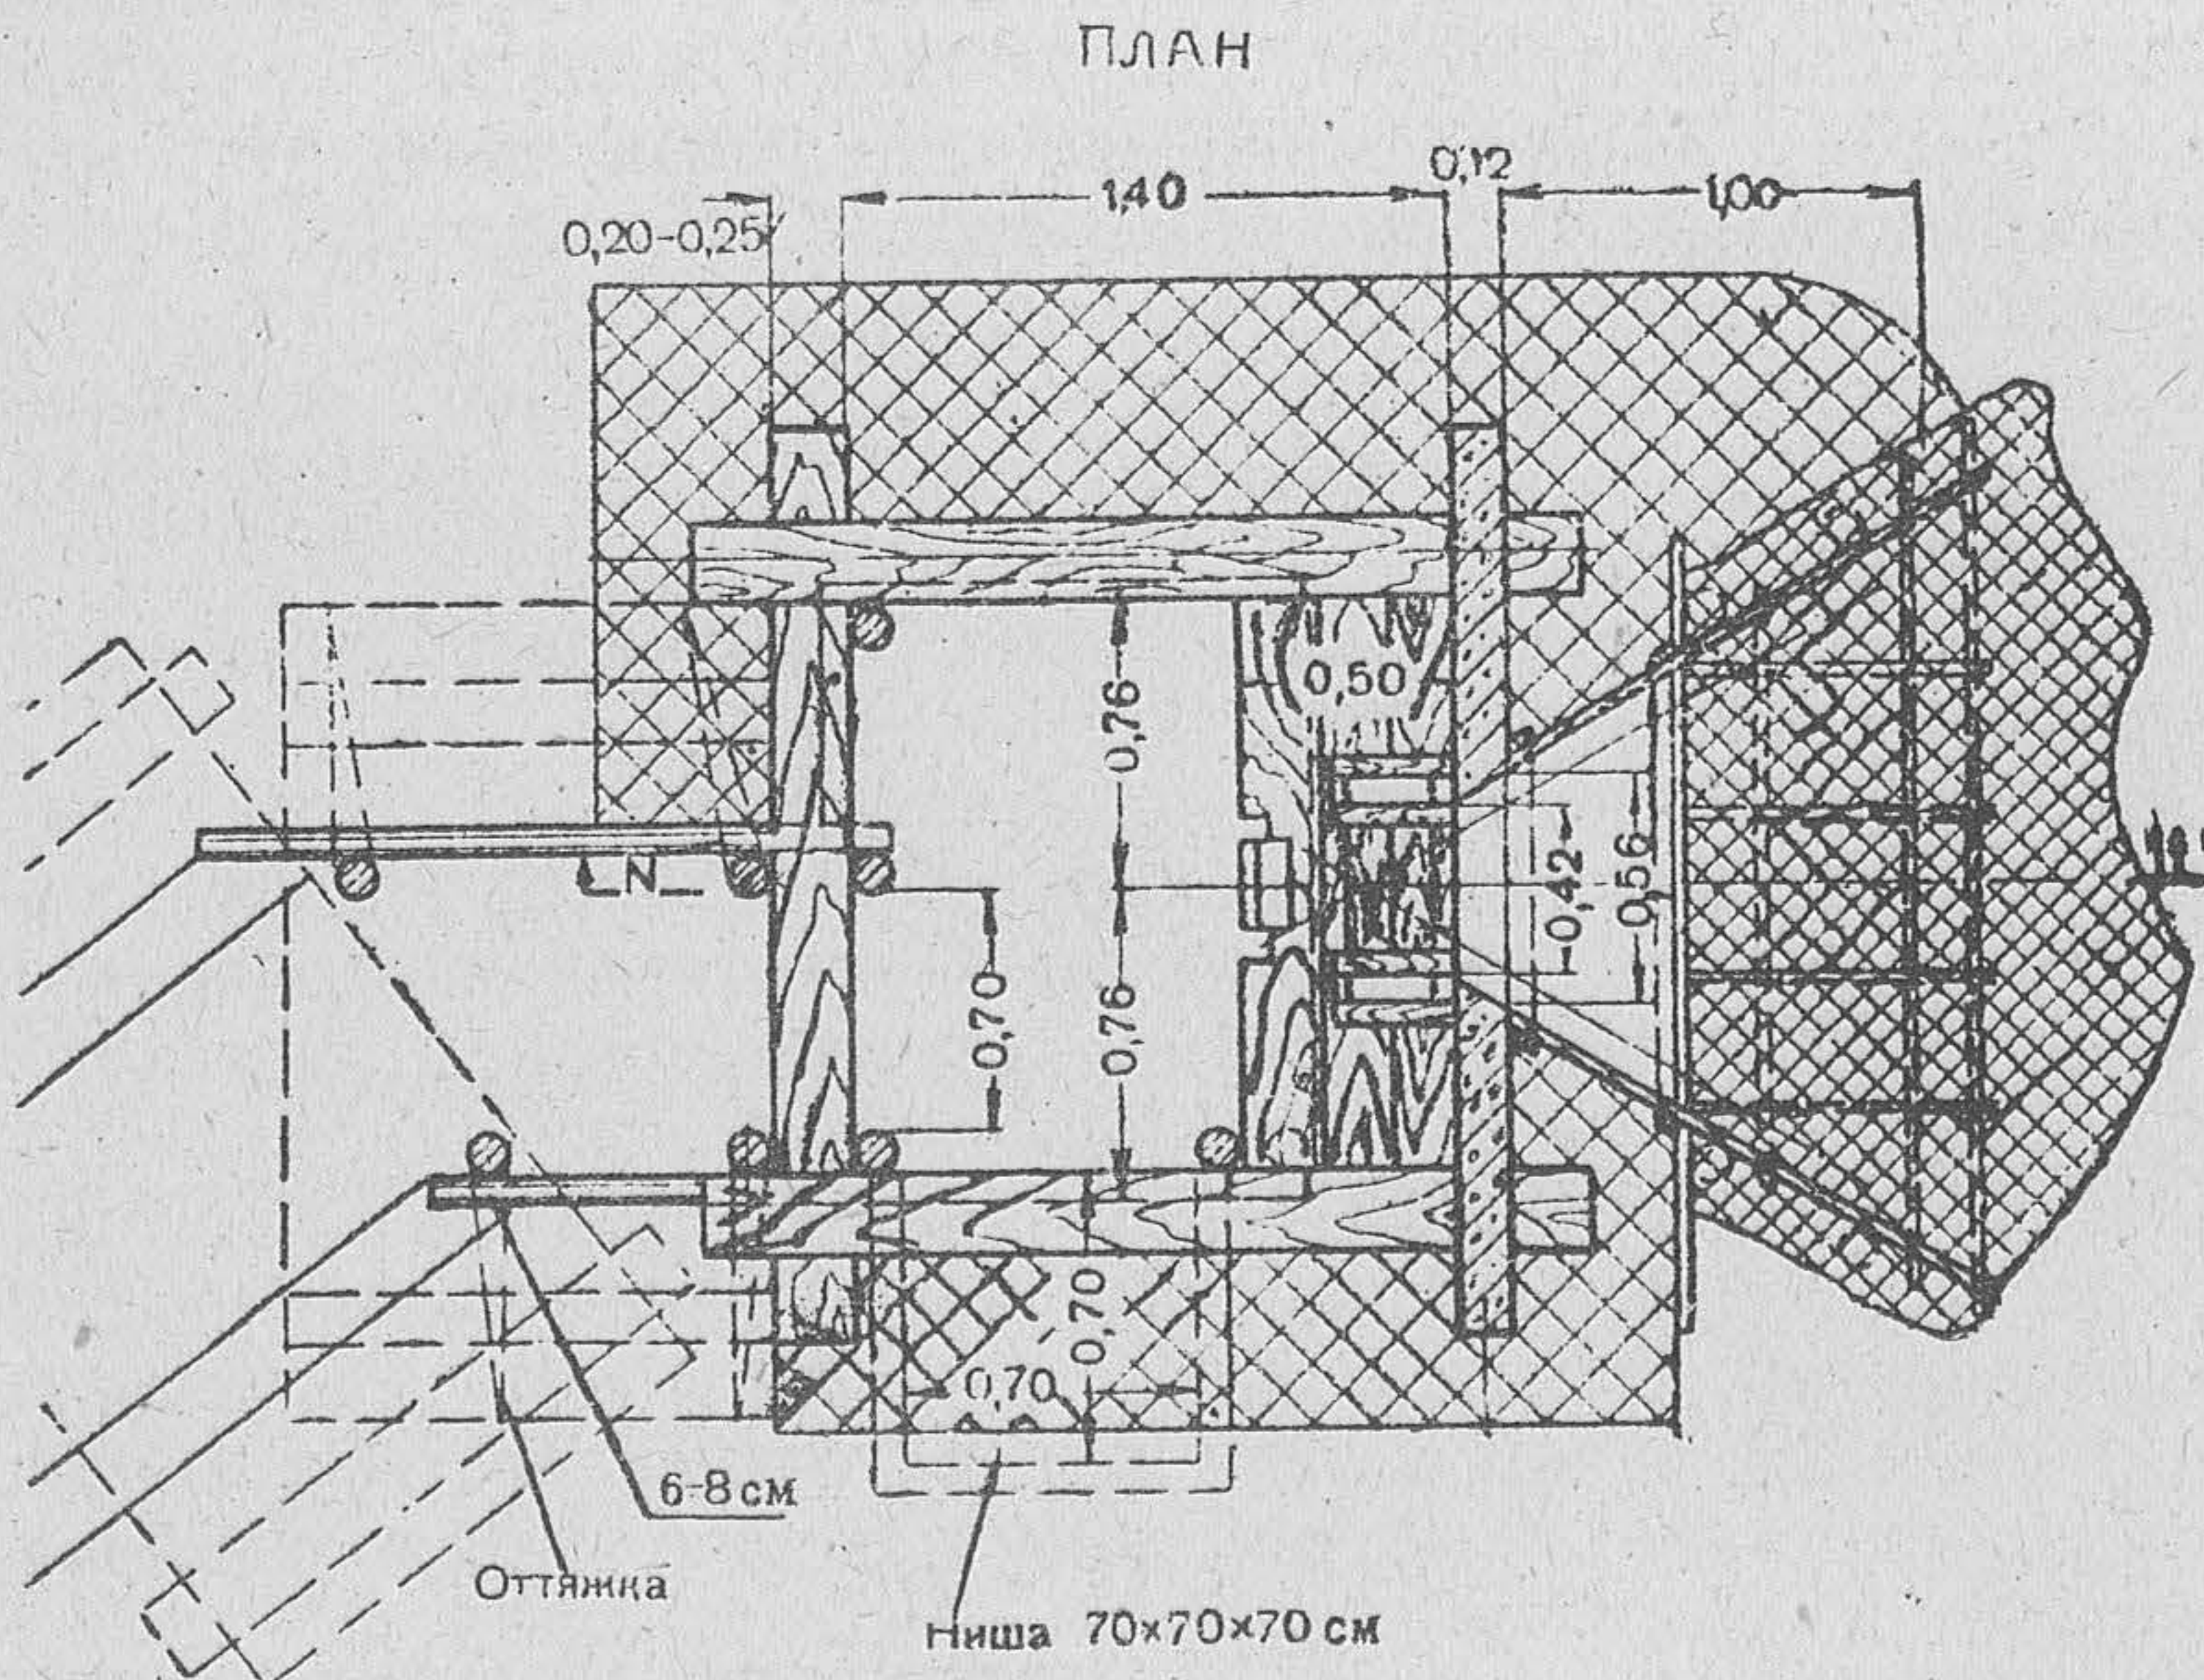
Сборное пулемётное сооружение из железобетонных и деревянных балок
